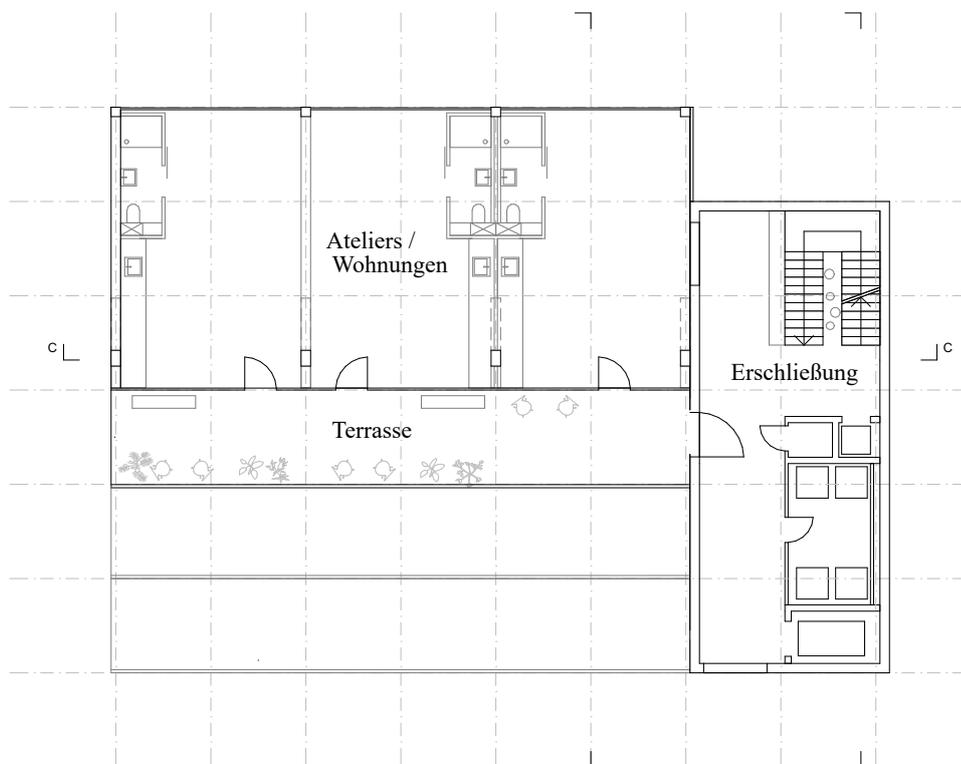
Grundriss Drittes Obergeschoss, M 1:250
